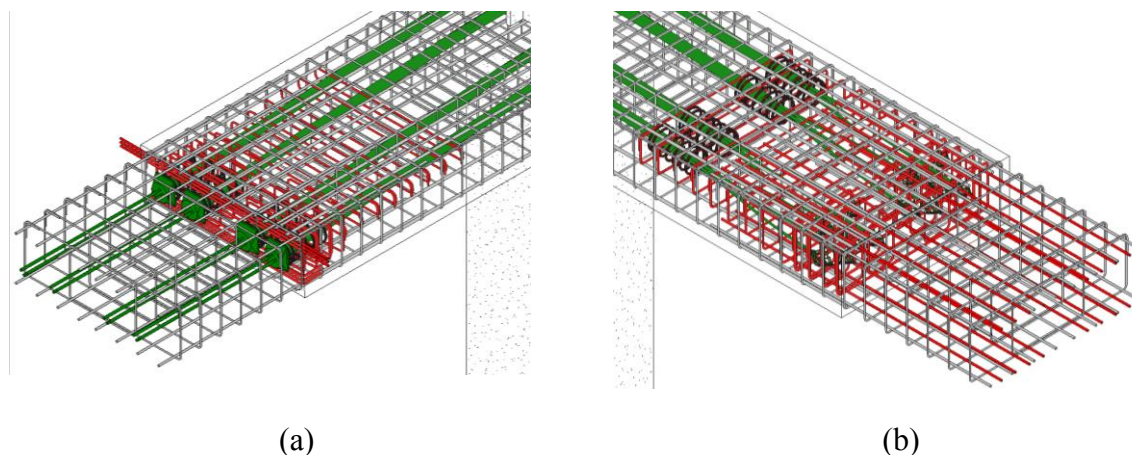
Modelação do objeto BIM –nichos: (a) vista com armaduras de reforço; (b) vista após a aplicação do pré-esforço. Armaduras de reforço a vermelho e ordinárias a cinzento.
